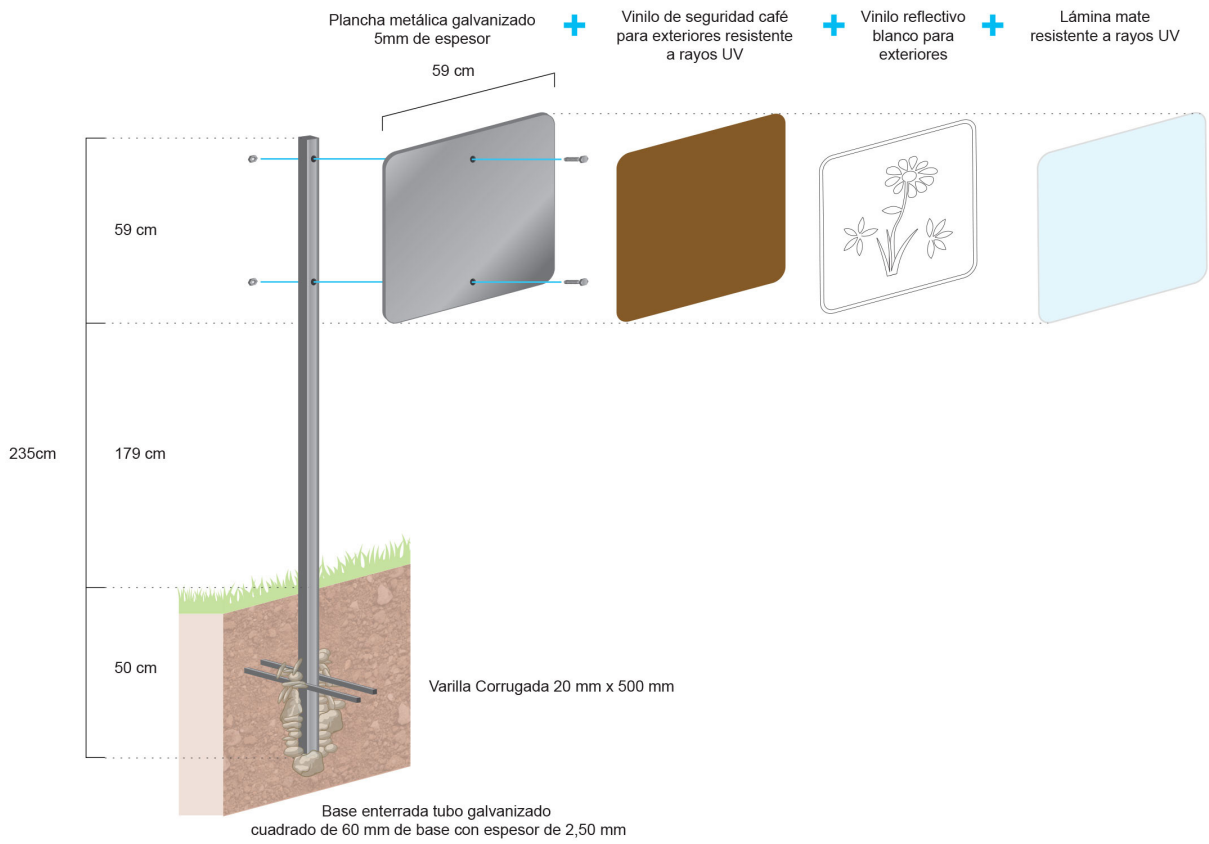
Detalle constructivo para señales puntuales de atractivos.
